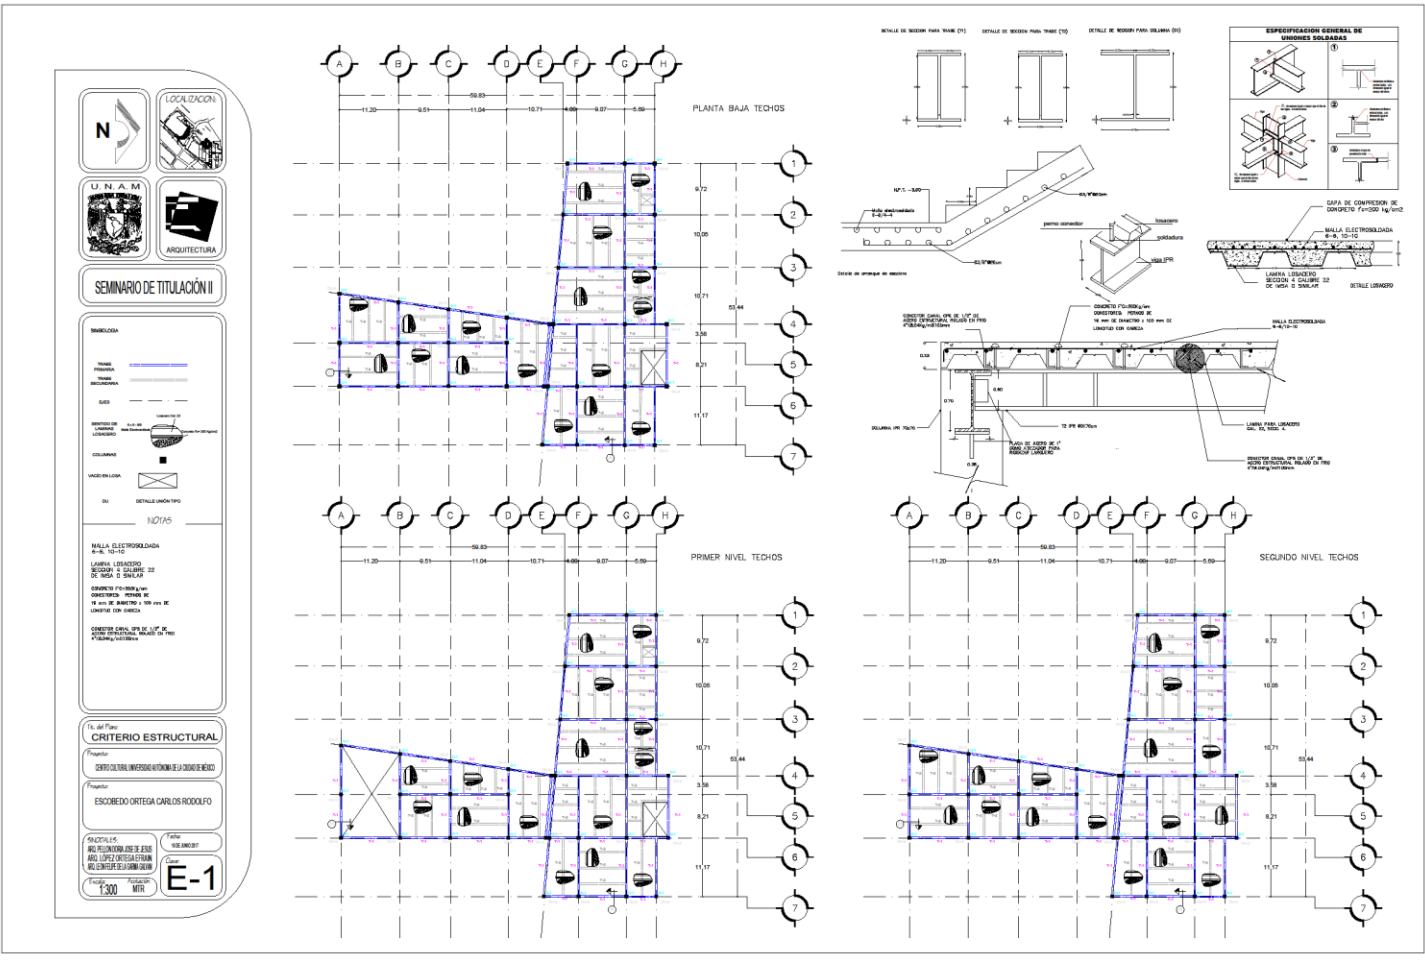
Planos estructurales de los 3 niveles del Centro cultural UACM plantel Cuauhtemoc. Creación propia.
